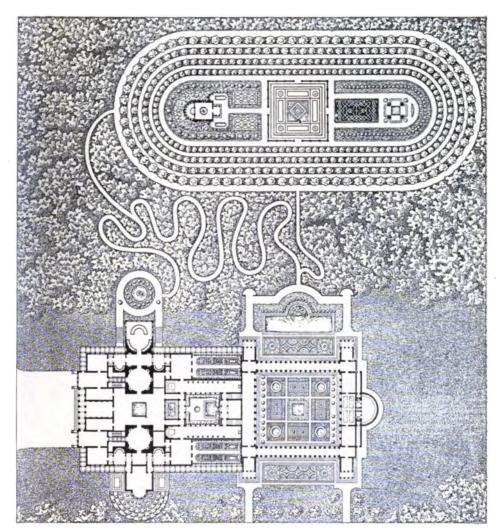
Entwurf zu einem großen Lanbhaus bei Charlottenhof. Grunbriß und Gartenanlagen. 1833.
